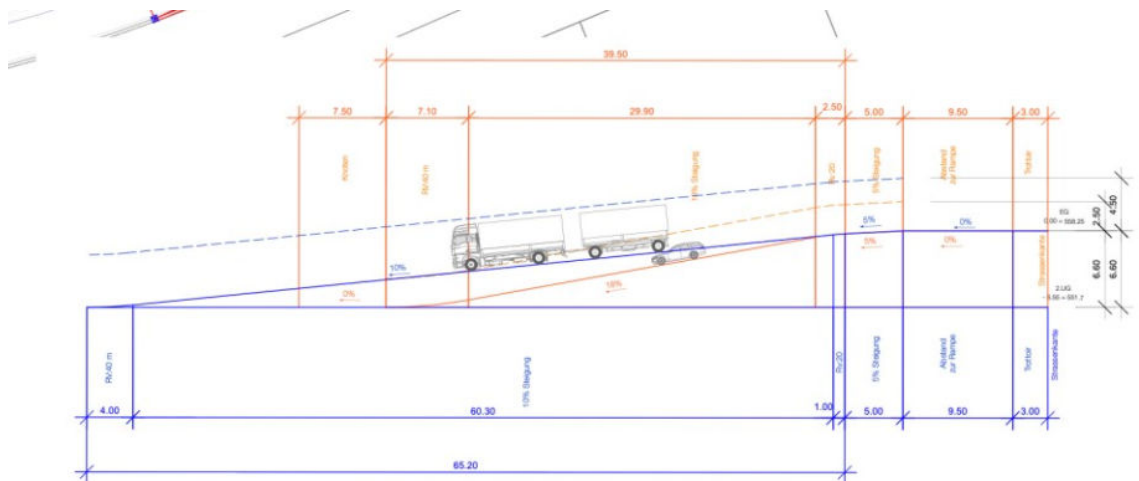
Schnitt durch Rampe Ein- und Ausfahrt AEH und Ausfahrt LKW [Quelle: IBV Hüsler AG, Workshop 02, Stand 16.03.23]
